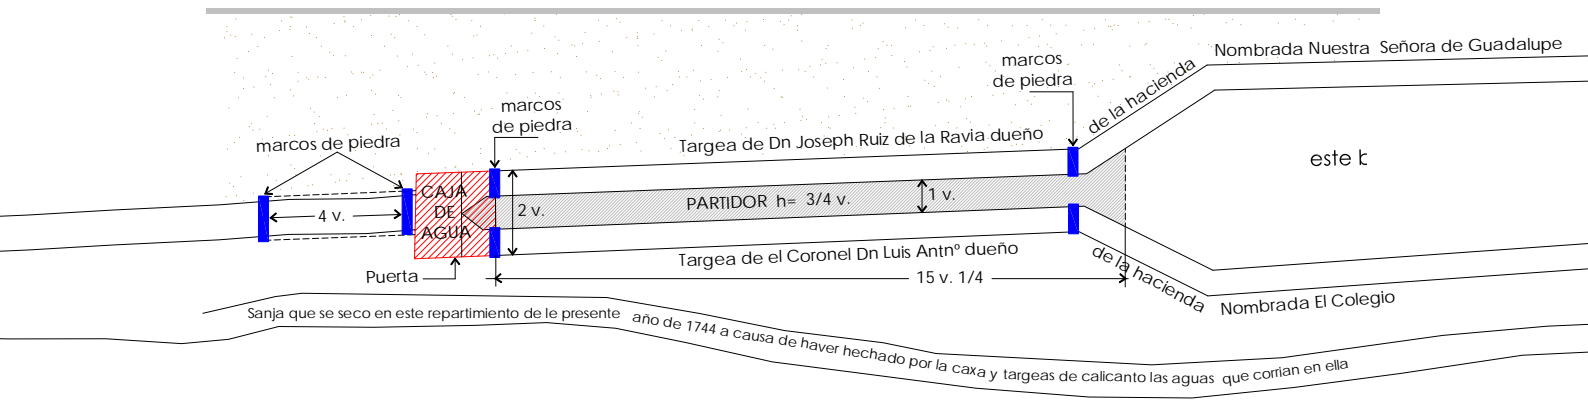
Detalle del plano realizado en el año de 1743. Reconstrucción MGMR.
